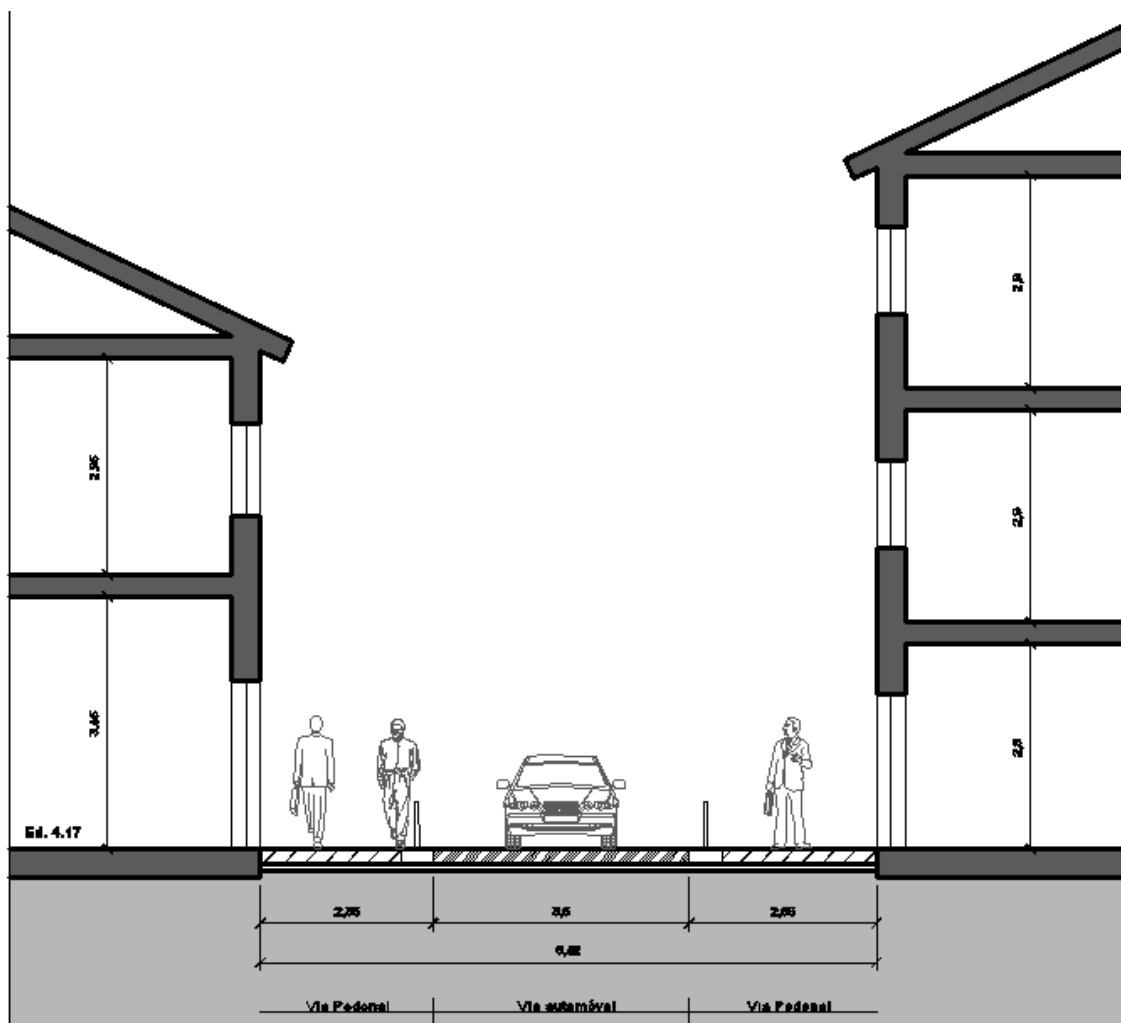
Perfil tipo de proposta de arruamento (anexo b.10)
